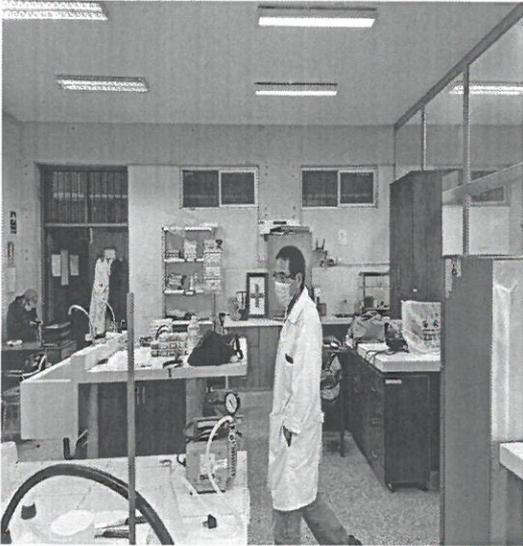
Se observa ausencia de pintura en vigas y columnas, piso desgastado por el uso y puertas sin mantenimiento.
